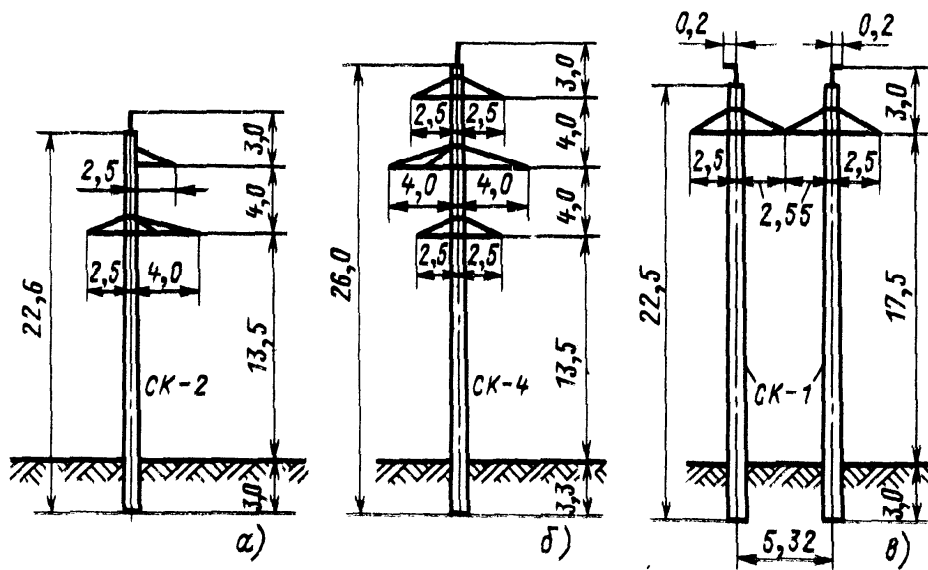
Унифицированные железобетонные опоры 150 кВ
